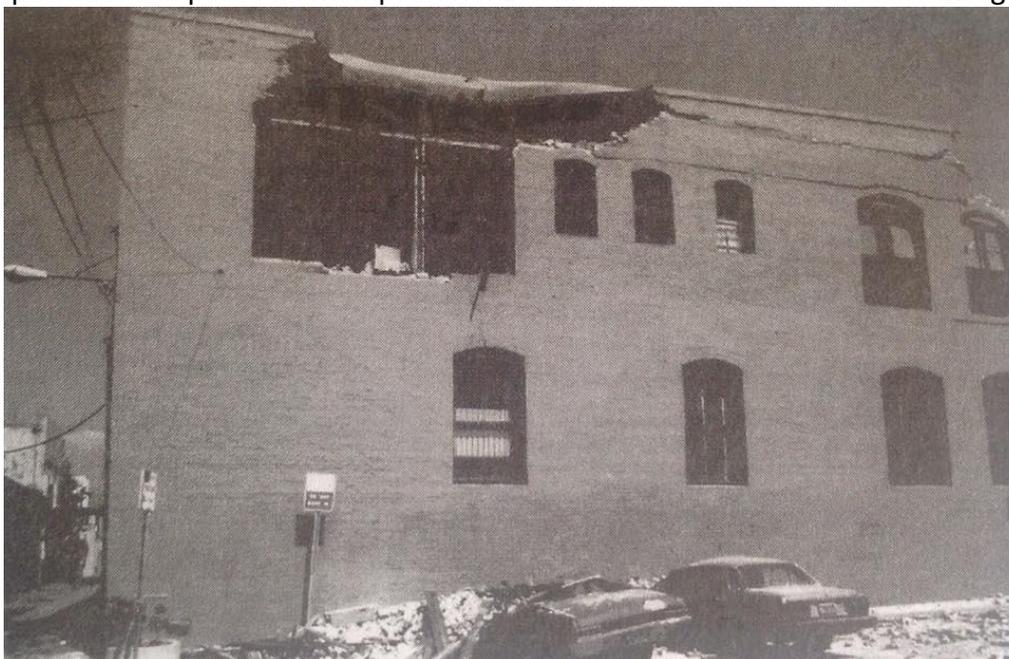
La pared de mampostería sin refuerzo estructural tiene daños en su propio plano. El tope de la pared ha colapsado y es una amenaza de caída de material inminente. La edificación se marcó como insegura y el parqueadero fue restringido.
